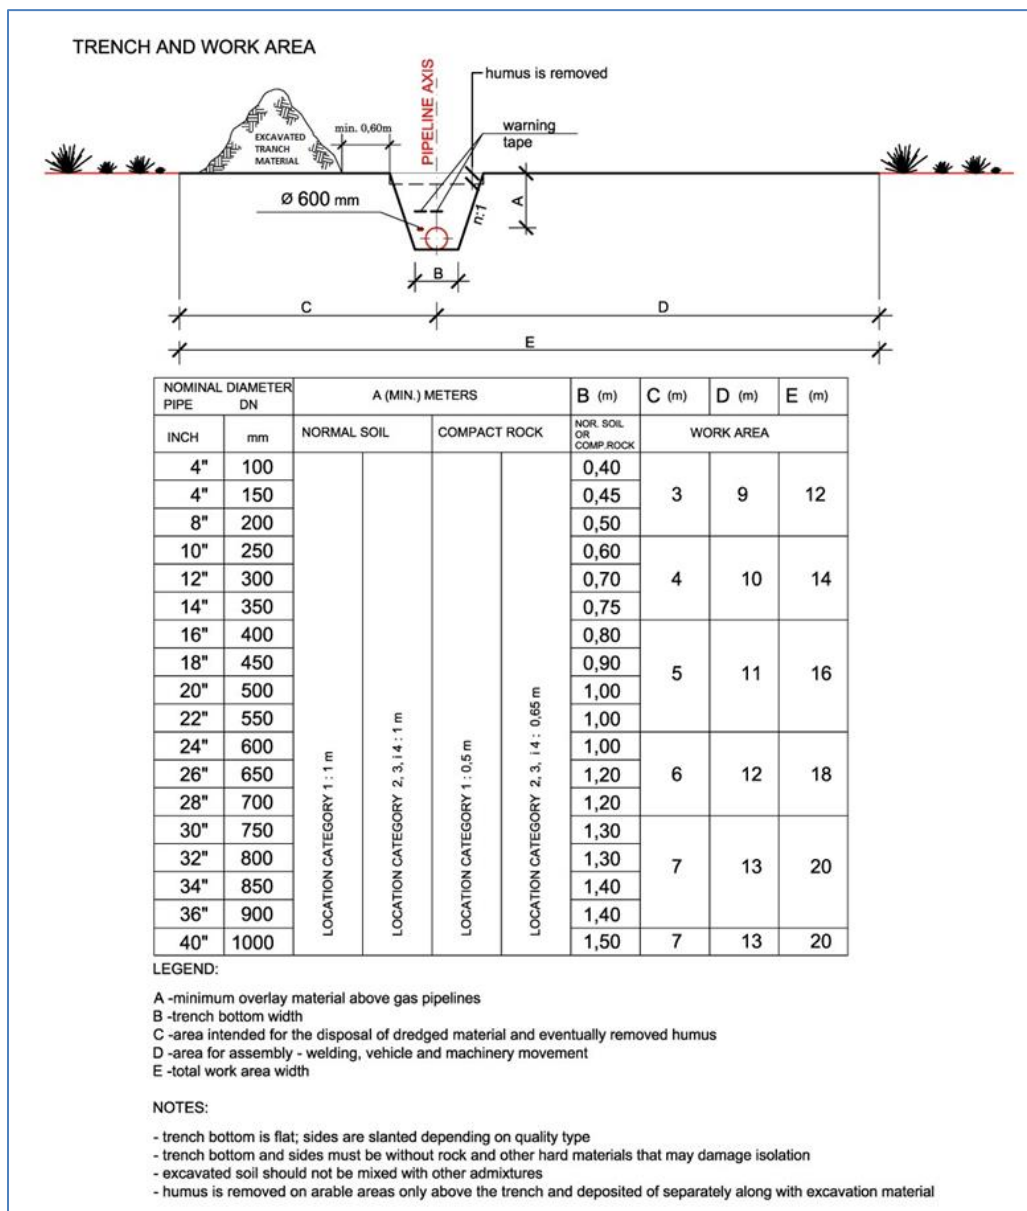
Kanali i tubit dhe zona e punës / Pipeline trench and working area⁶⁶
